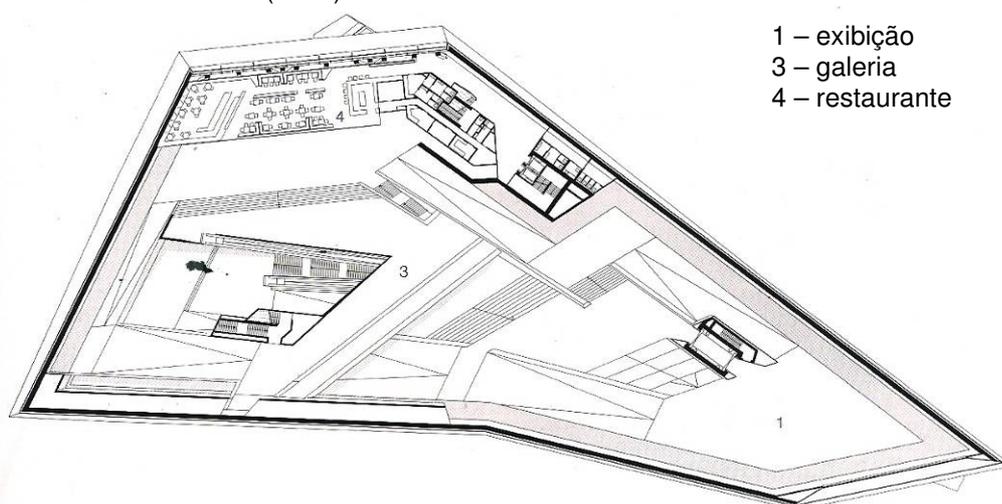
Planta de cobertura do Pavimento de Acesso.
